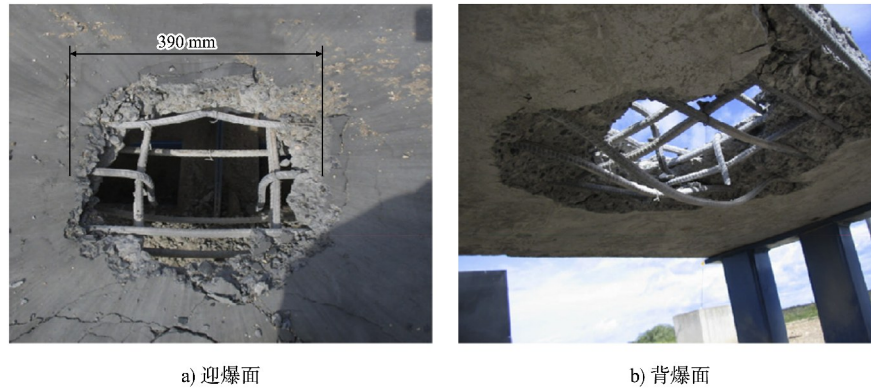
钢筋混凝土面板接触爆炸下的典型破坏现象
